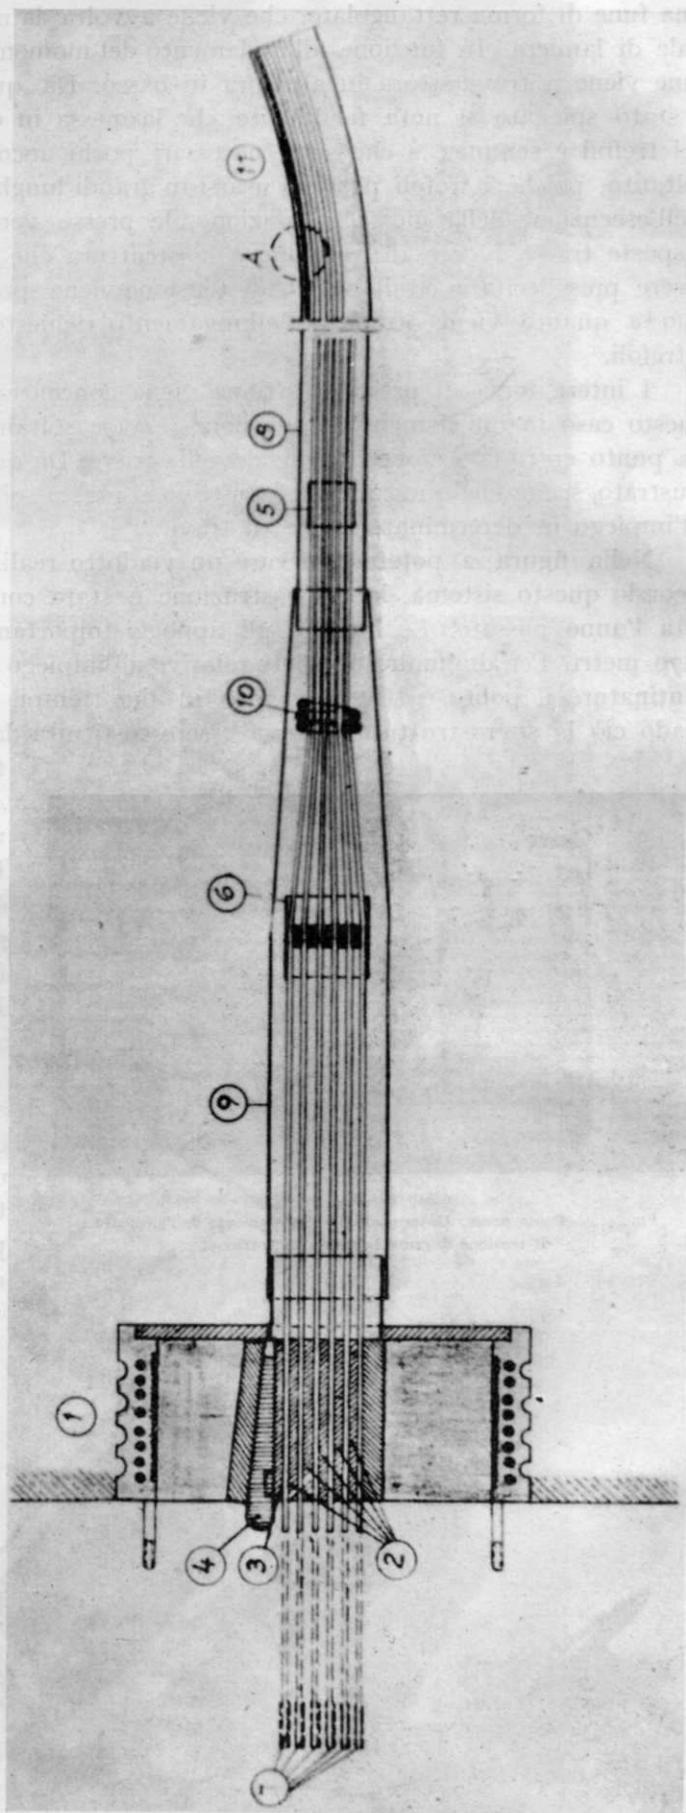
Rappresentazione schematica delle disposizioni del sistema.
